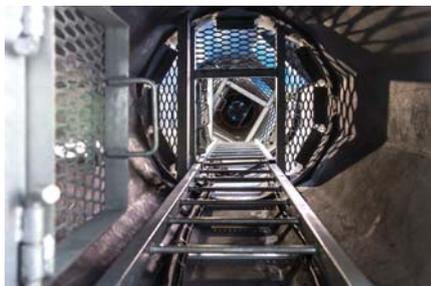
Лестница и площадки для отдыха внутри ствола опоры цифрового переходного пункта
